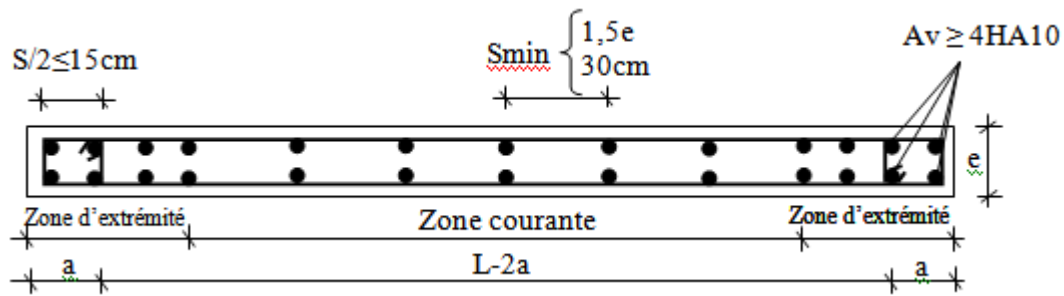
Disposition des armatures verticales dans les voiles
